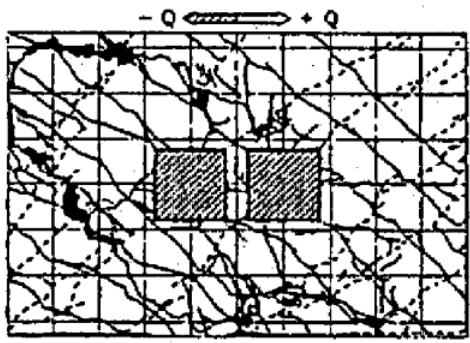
実験での最終ひび割れ状況¹⁵⁾
